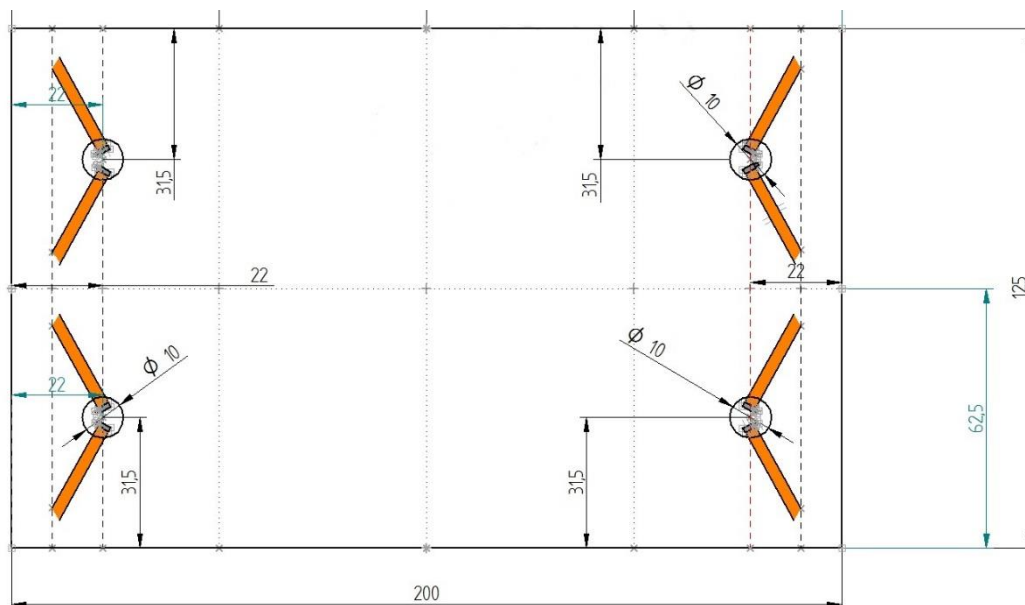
Technische Zeichnung Carbo e-Wall®, Rückseite, Bemaßung in cm
